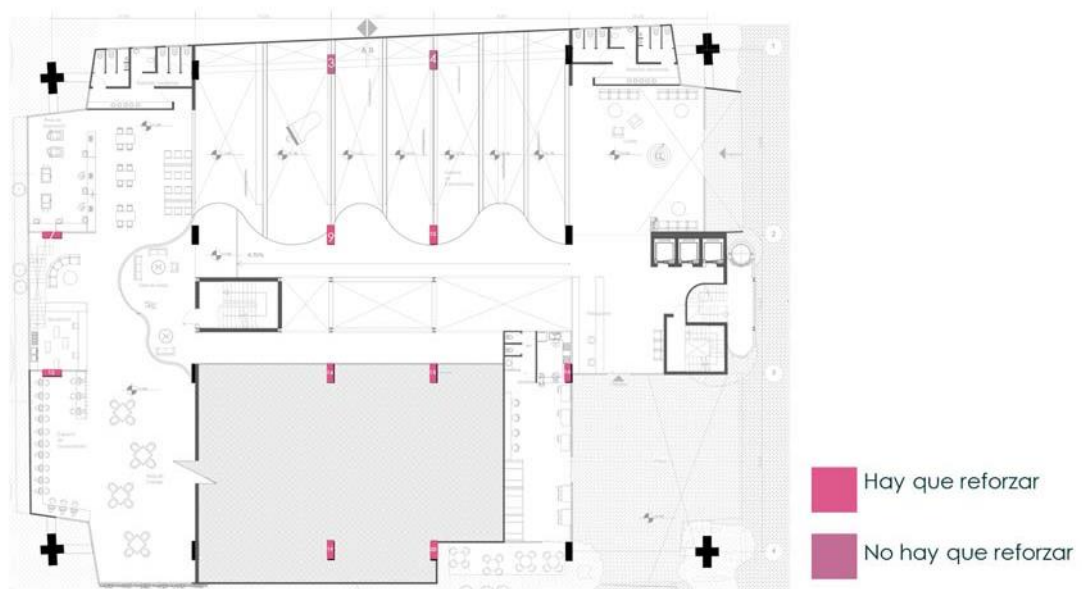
Planta Baja reforzamiento de columnas. Elaboración propia.
